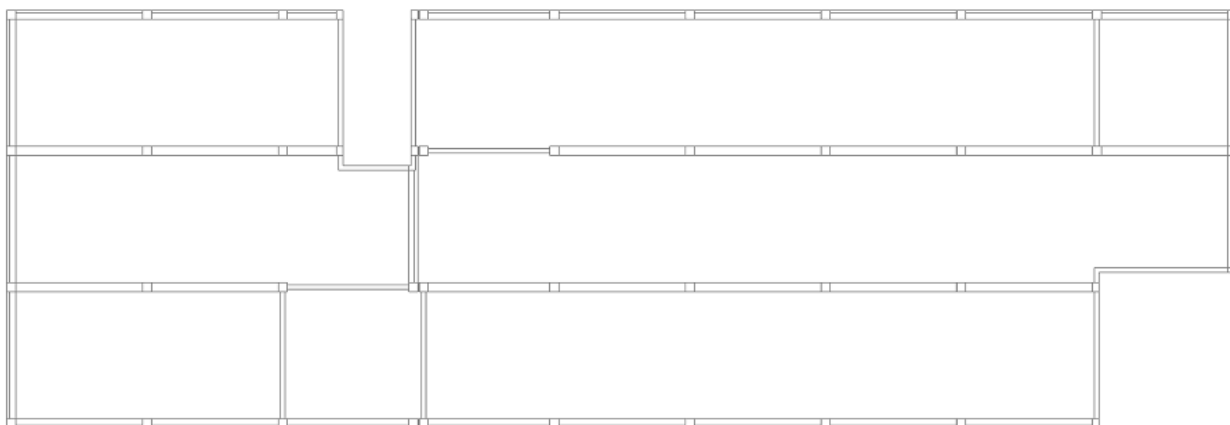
Расчётная схема монолитной плиты перекрытия
